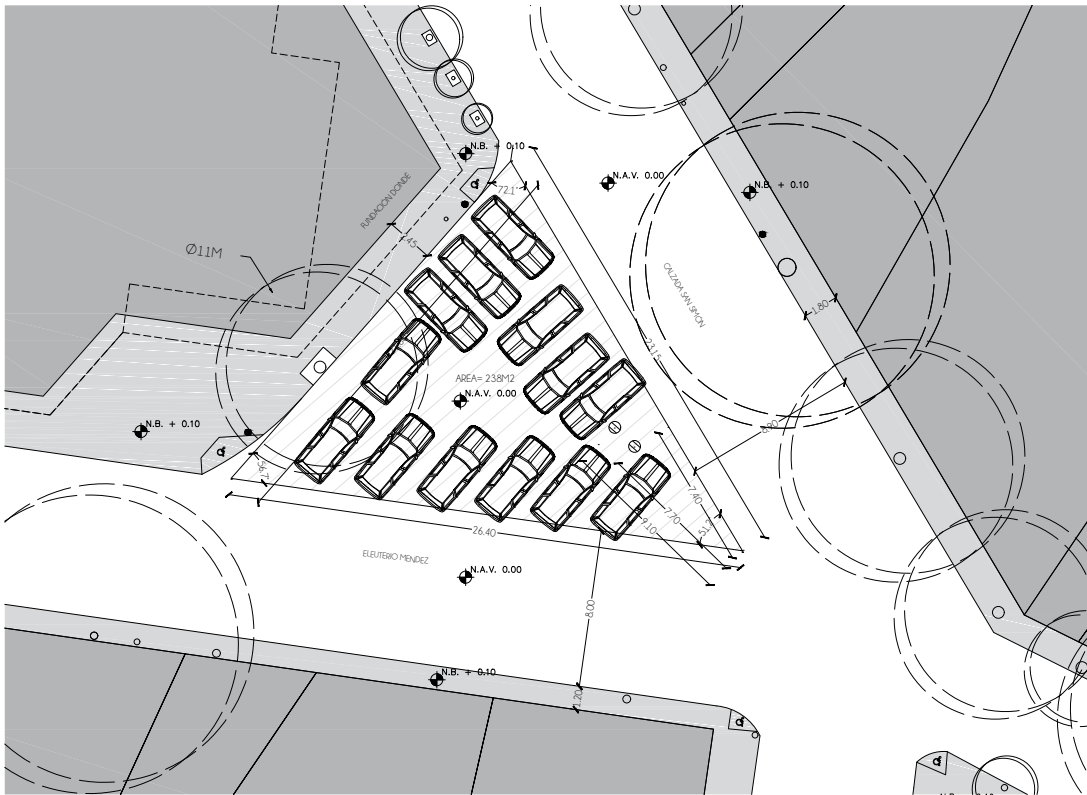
Plano de levantamiento del estado actual del predio. Elaboración propia.
